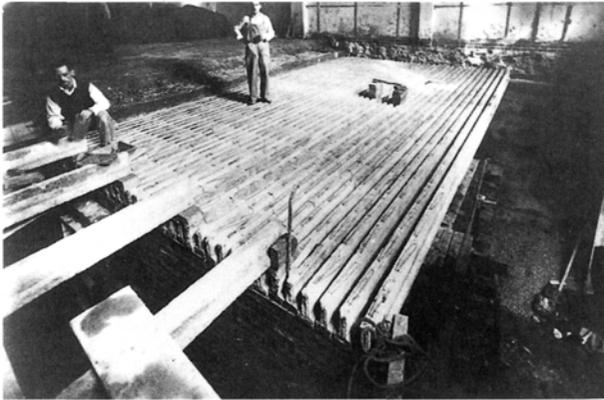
Forjado de viguetas pretensadas con losa de hormigón in situ para una sobrecarga de 2.500 kg/m², realizado en la década de 1950.
